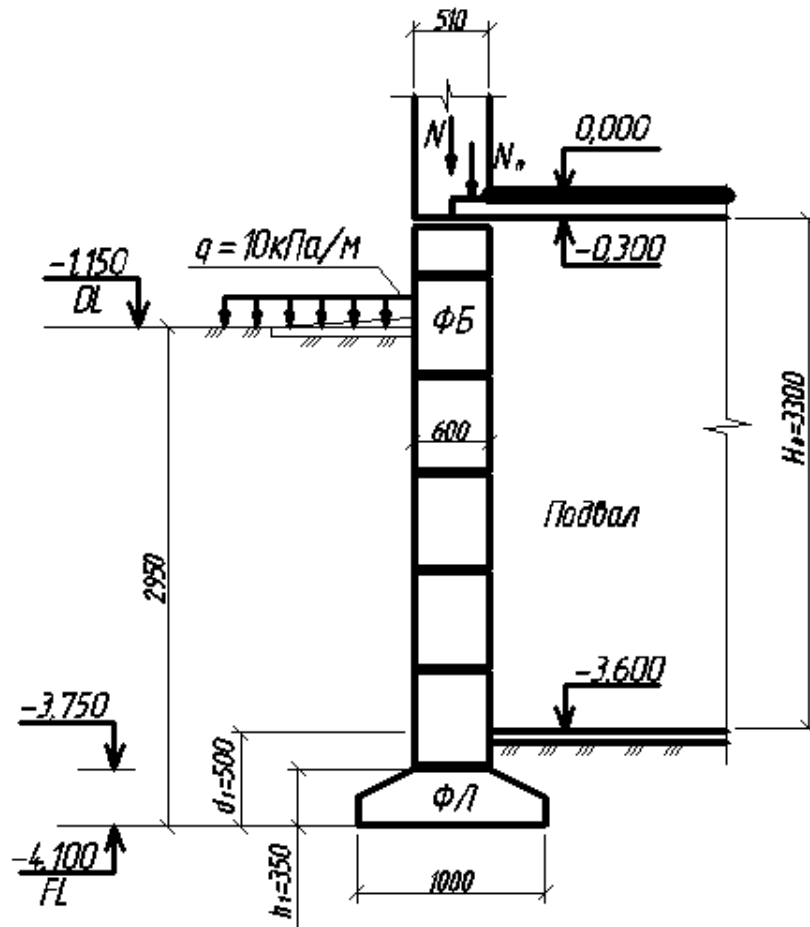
Расчетная схема и конструкция фундамента к примеру 2
